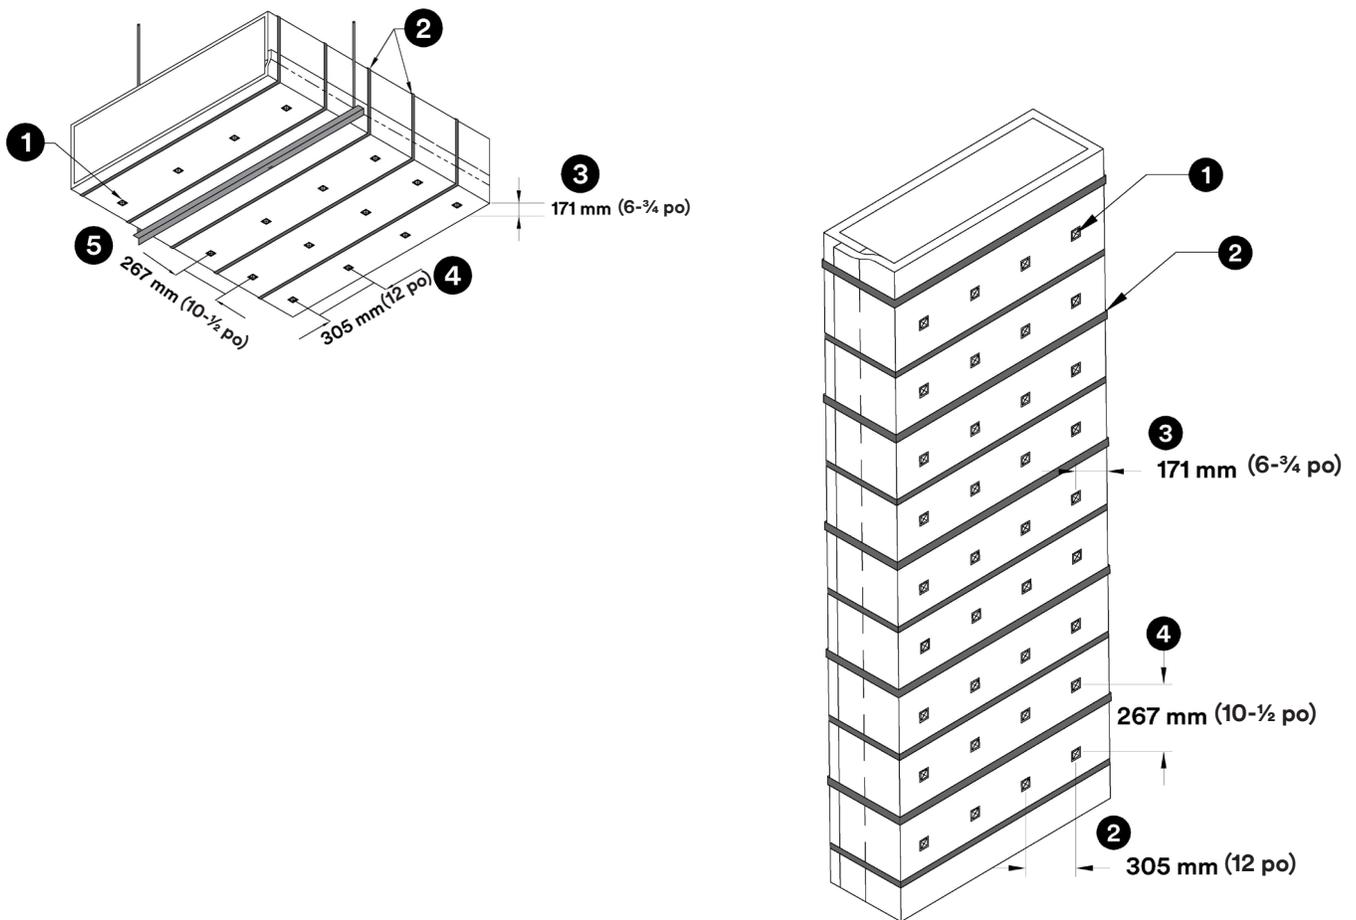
Techniques de chevillage et de cerclage des conduits horizontaux et verticaux pour la technique d’installation en télescopage
